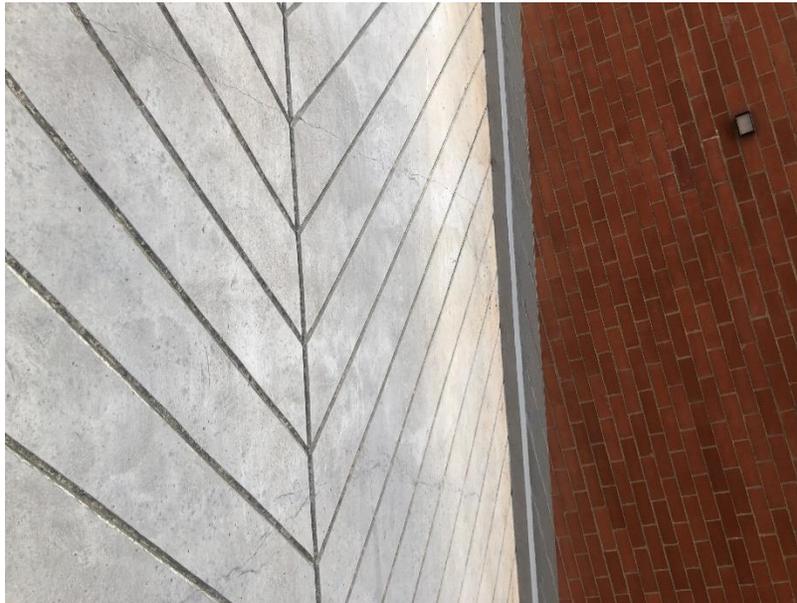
Fisuras en general en toda la rampa de acceso a sótano
